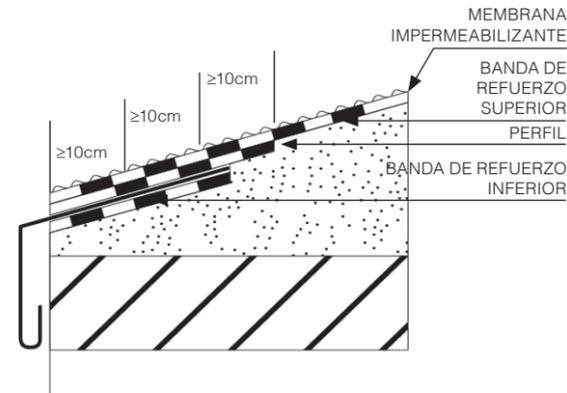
Detalles de bordes de la cubierta impermeabilizada
